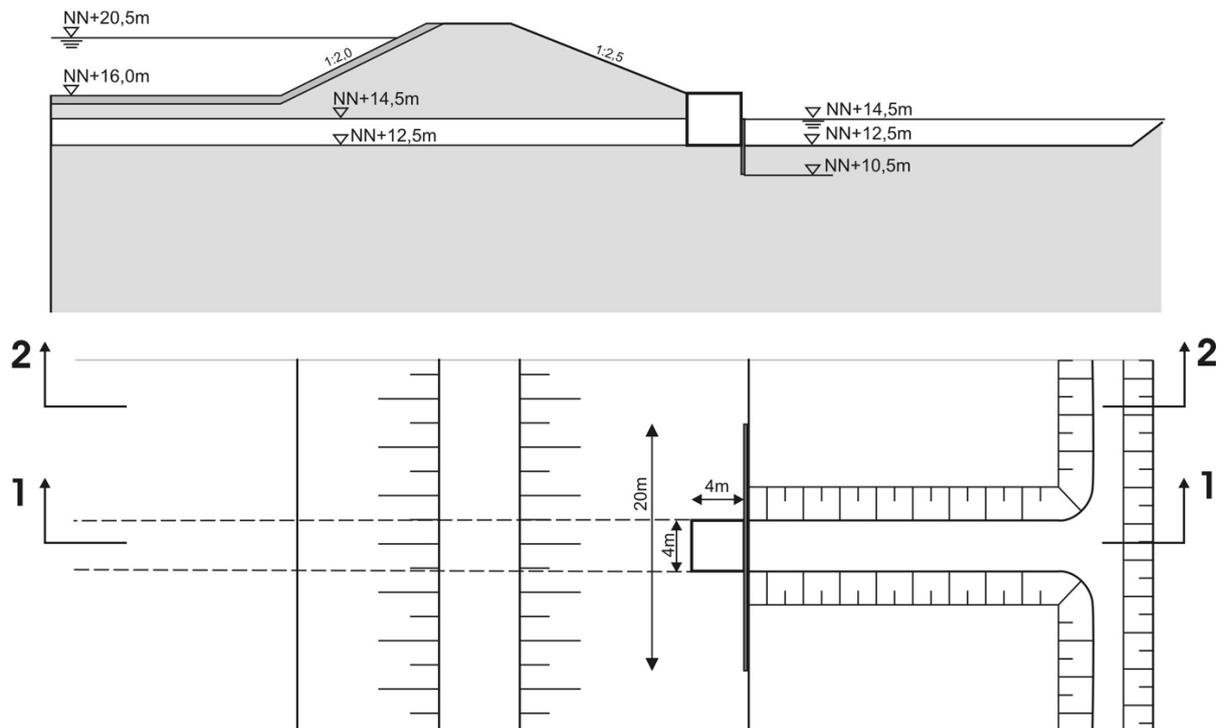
Längsschnitt 1-1 (oben) und Draufsicht des Durchlassbauwerks (unten)
